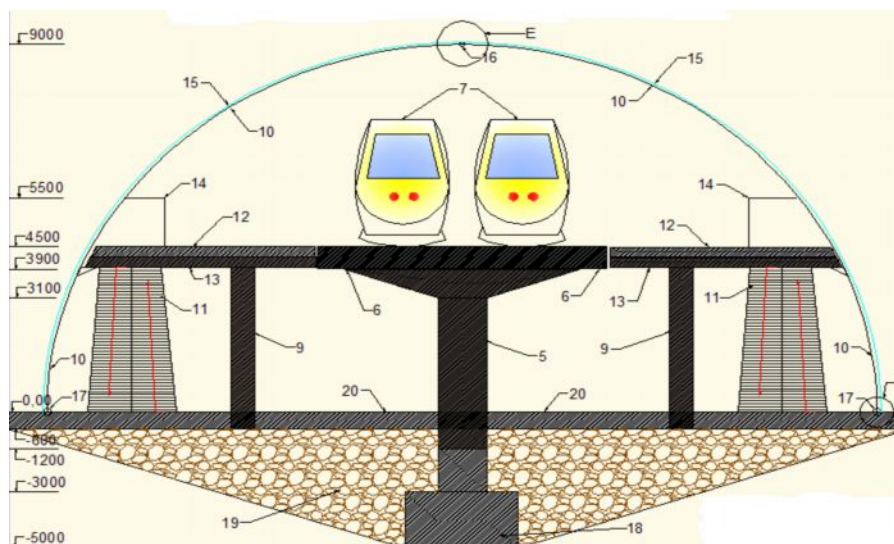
Разрез станции: 5 – опоры пролетного строения, 6 – пролетное строение, 9 – опоры платформы, 10 – металлические балки-арки, 11 – эскалаторы, 12 – платформа, 13 – ригель платформы, 14 – перила, 15 – стеклянные панели, 16 – шарнирный узел кровельного сопряжения арок, 17 – шарнирный узел наземного сопряжения арок, 18 – фундамент, 19 – грунты основания, 20 – фундаментная плита.
